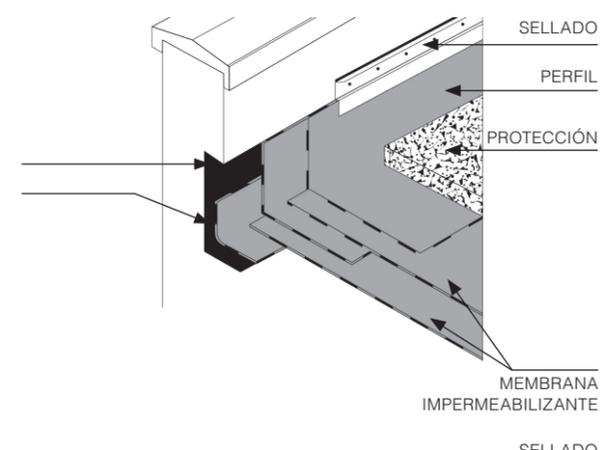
Detalles de encuentros con elemento vertical con perfil de protección
